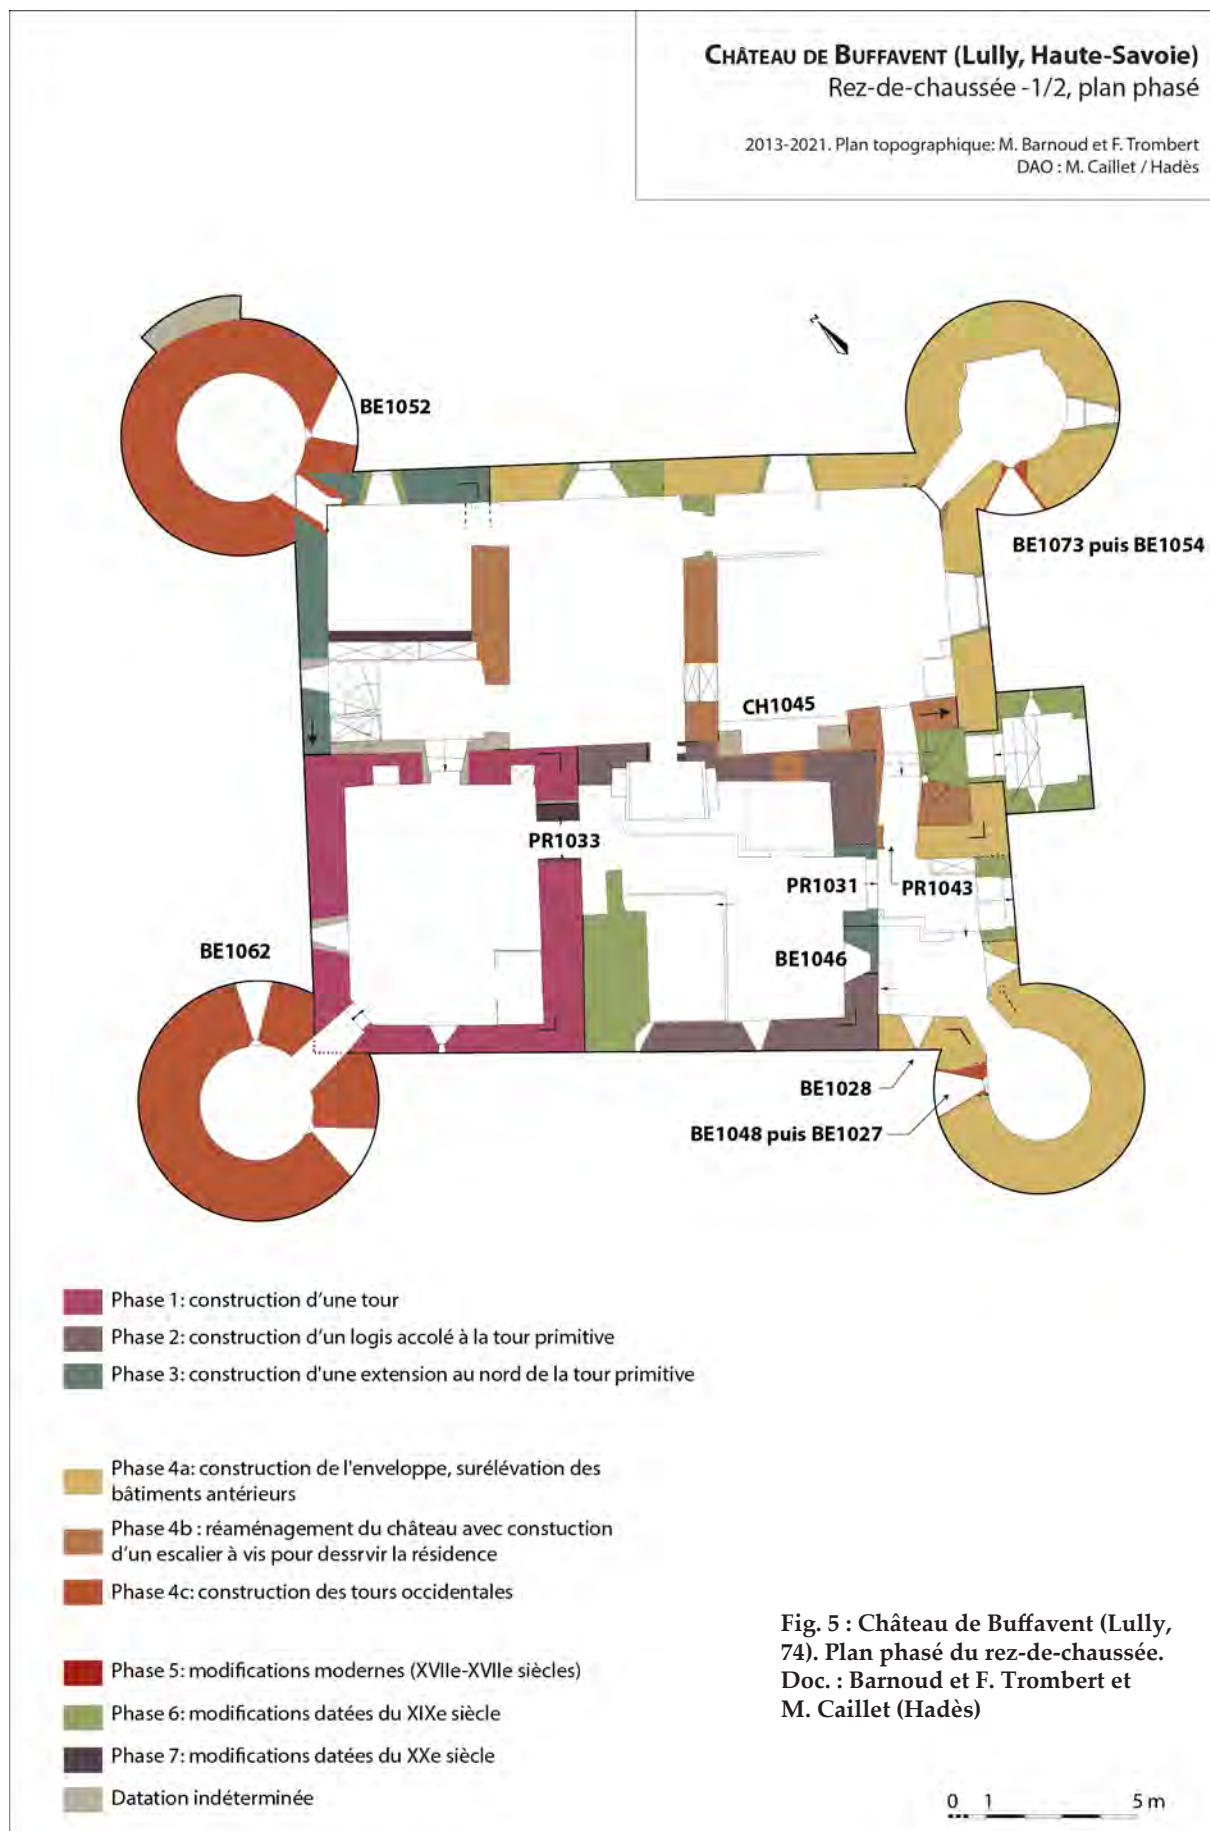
Château de Buffavent (Lully, 74). Plan phasé du rez-de-chaussée. Doc. : Barnoud et F. Trombert et M. Caillet (Hadès)
